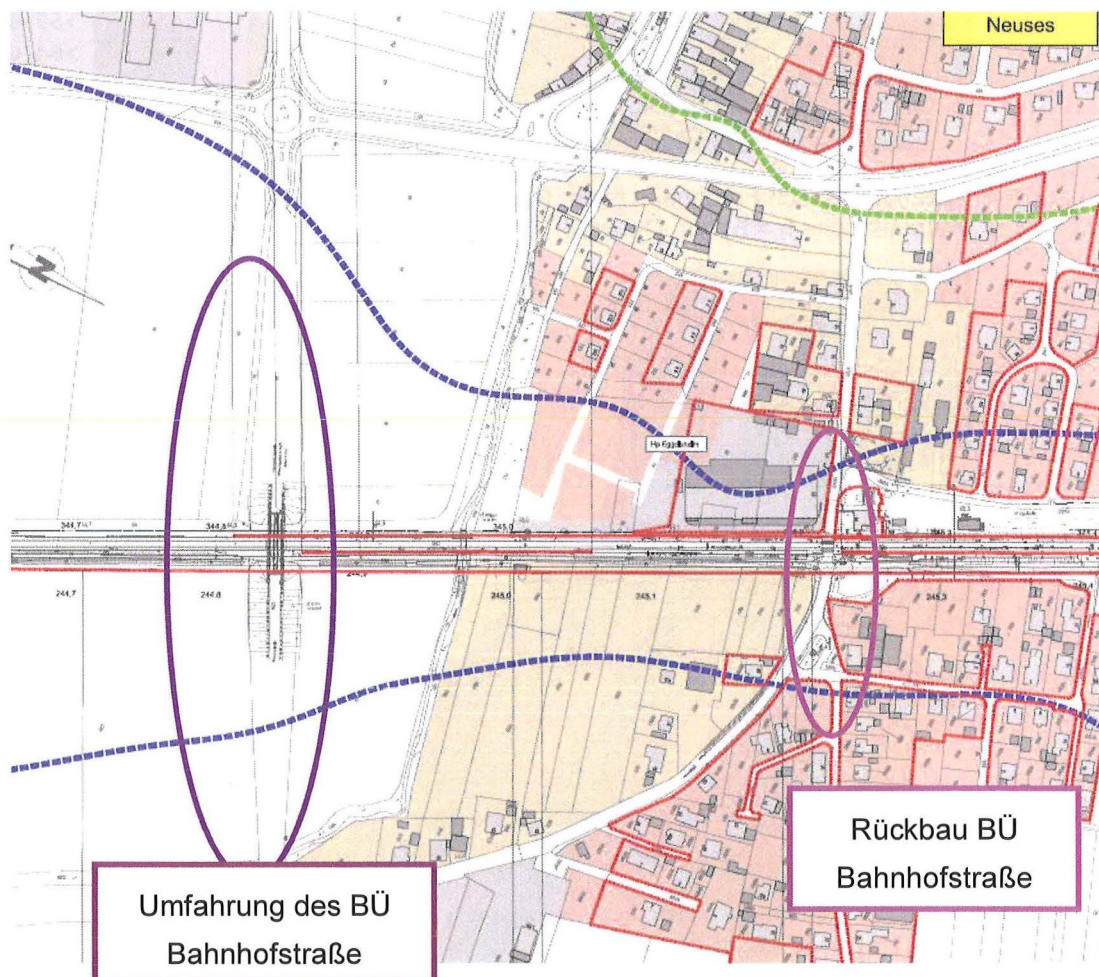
Übersichtslageplan der BÜ-Beseitigungsmaßnahme Bahnhofstraße
